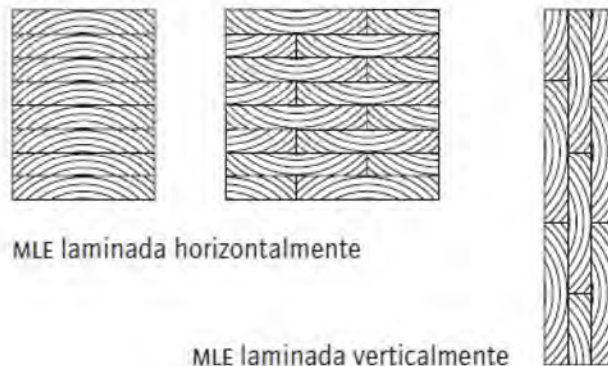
Elementos de madera laminada encolada en posición horizontal y vertical.
